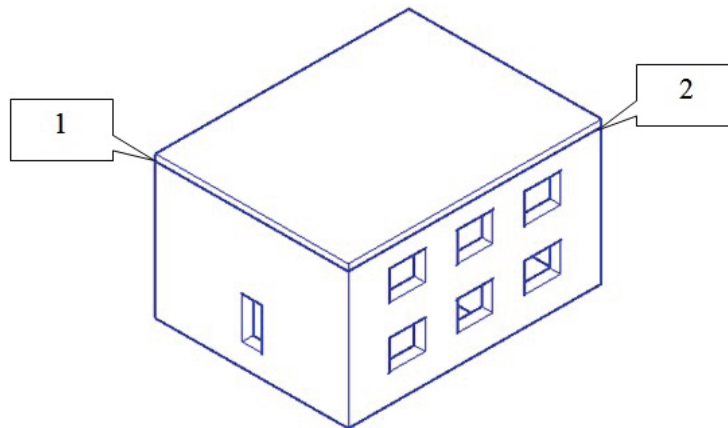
Создание перекрытия командой Ящик (Box)
